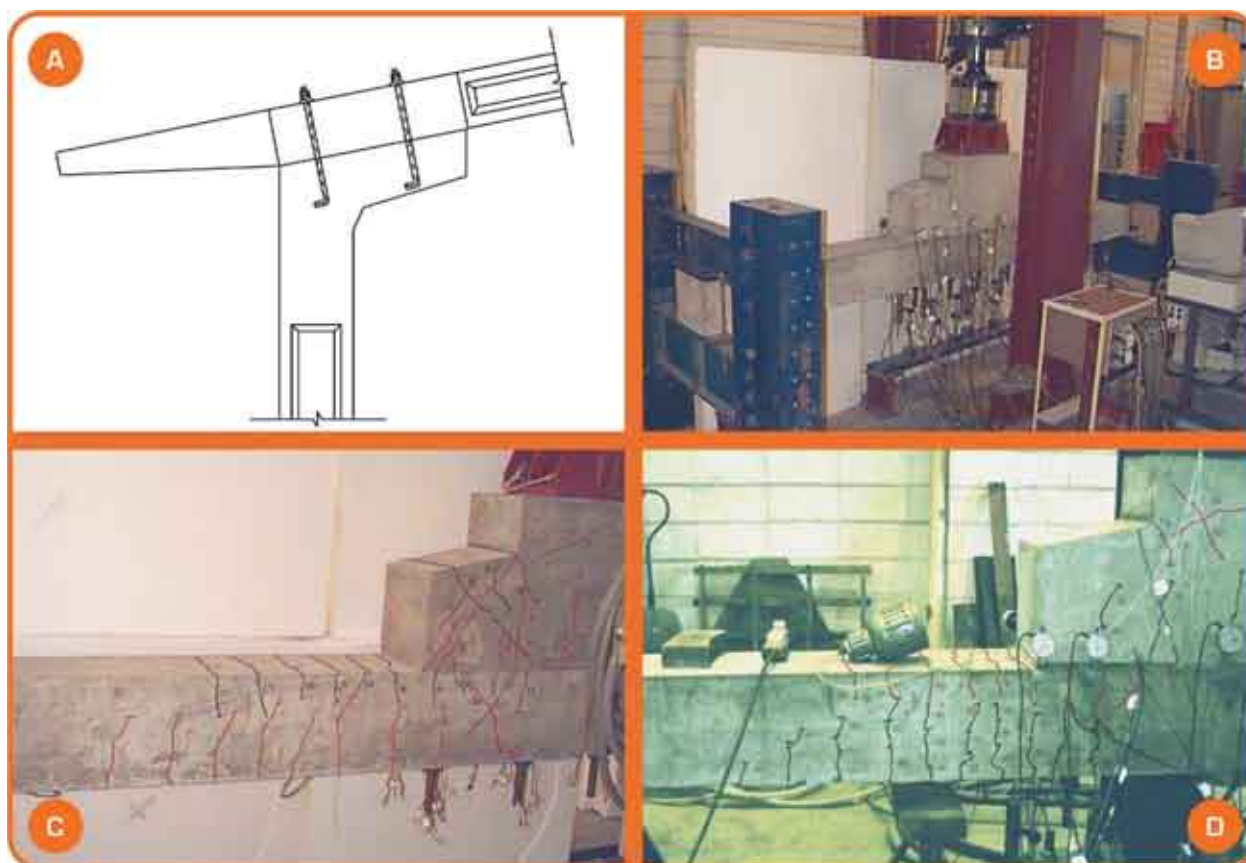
Ensaio de protótipo de ligação viga-pilar com almofada de CCRF: a) ligação estudada, b) ensaio da ligação, c) panorama de fissuras no protótipo sem almofada e d) panorama de fissuração com almofada [MIOTTO (2002)]
